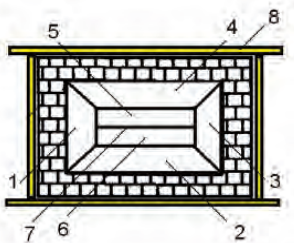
Схема предохранительной разрушающейся конструкции ограждения зданий.
